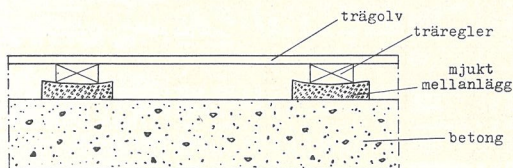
Trägolv som via fjädrande mellanlägg vilar på bärande betongplattor. Det fjädrande mellanlägget kan bestå av speciellt utformad gummi, kork, glasull, rockwool eller helt enkelt av vanlig sågspån.
